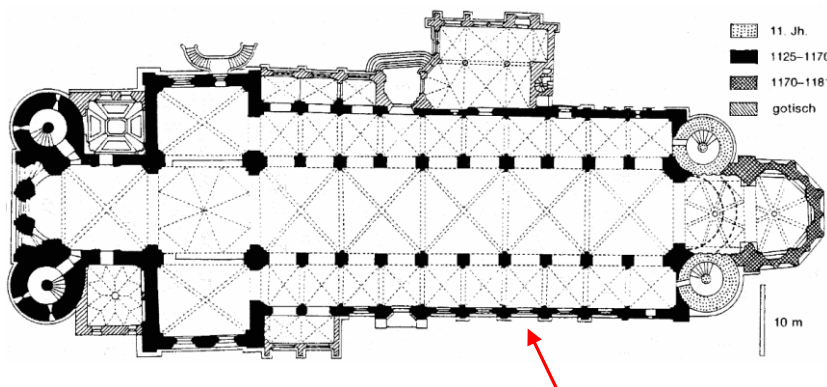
Grundriss mit Kennzeichnung der Lage der Probeachse (roter Pfeil) auf der Nordseite [aus <http://www.kirchbau.de/>]
